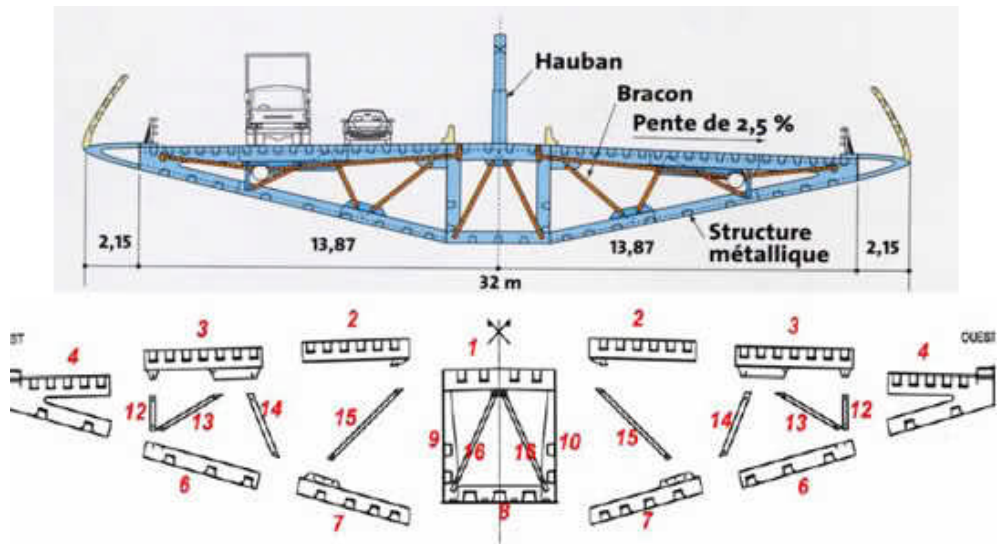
Sección de tablero de puente atirantado (Viaducto de Millau)
